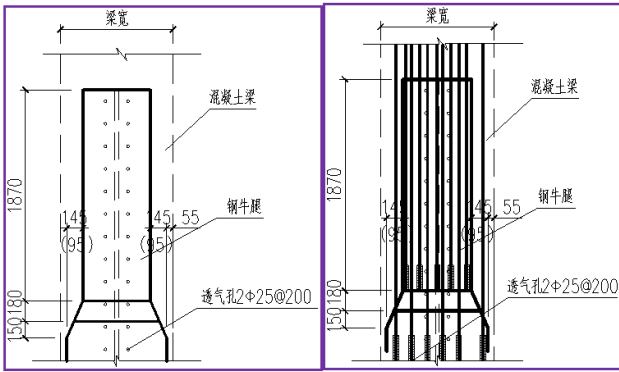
变截面(折线形)钢牛腿 CAD 深化平面图
